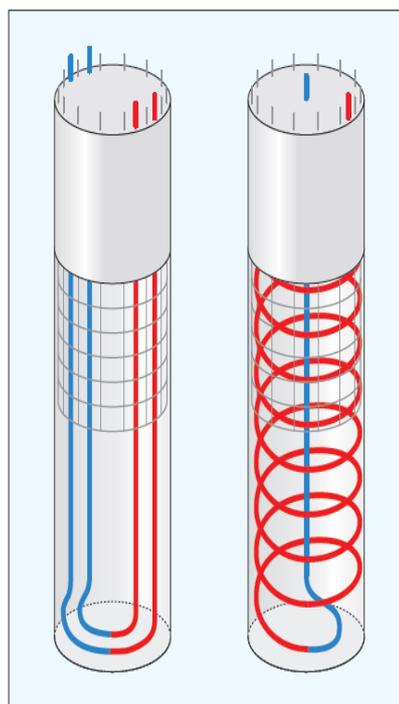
(Disposizione delle sonde geotermiche all'interno dei pali di fondazione) [5]
